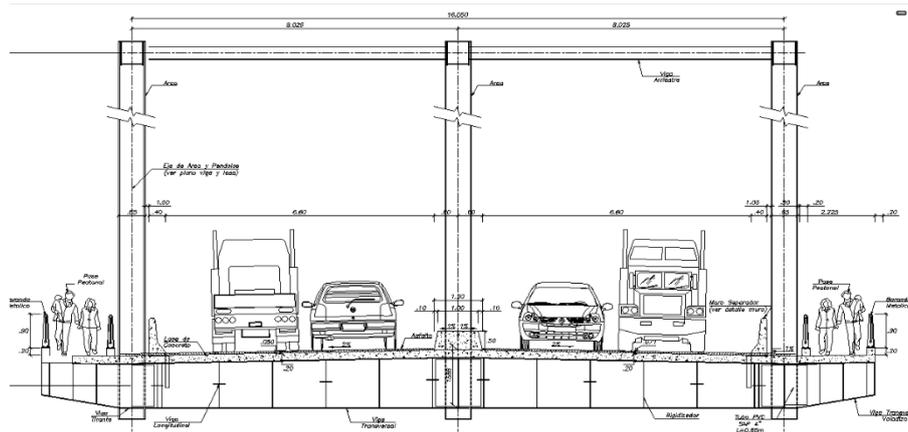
Vista en sección transversal del Puente Ñaña. (Fuente: AutoCAD, 2018)
